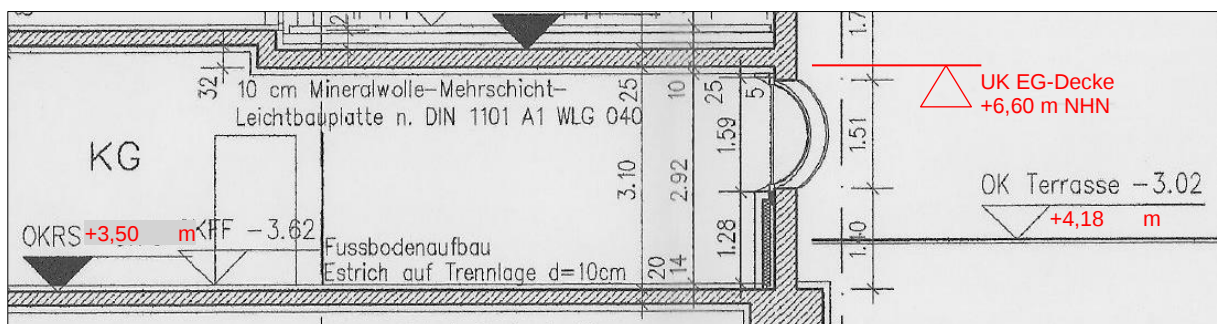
Teilabschnitt III & V – Schnitt Achse 20 des unterkellerten Bereichs (Ausschnitt aus dem Plan 533; Stand: 12.03.2001)
